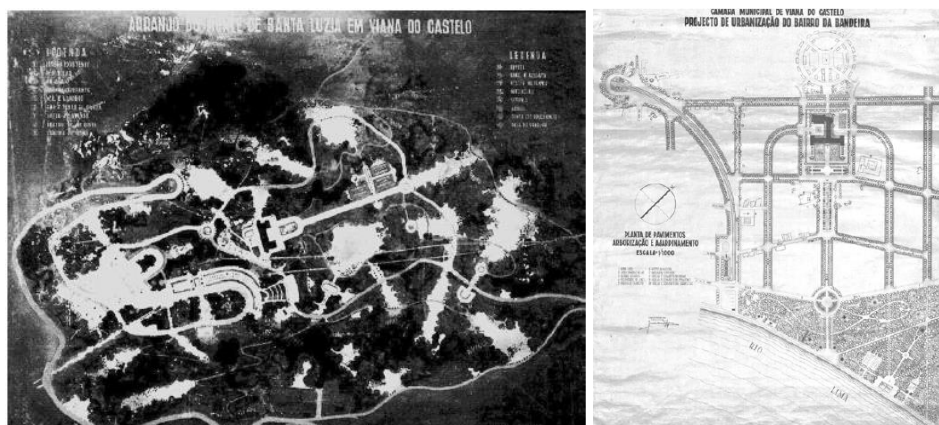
Plano de arranjo do Santuário de Santa Luzia pelo Arquitecto João Faria da Costa (esq.) e Projeto de Urbanização para o Bairro da Bandeira do Arquitecto João Aguiar (dir.)
